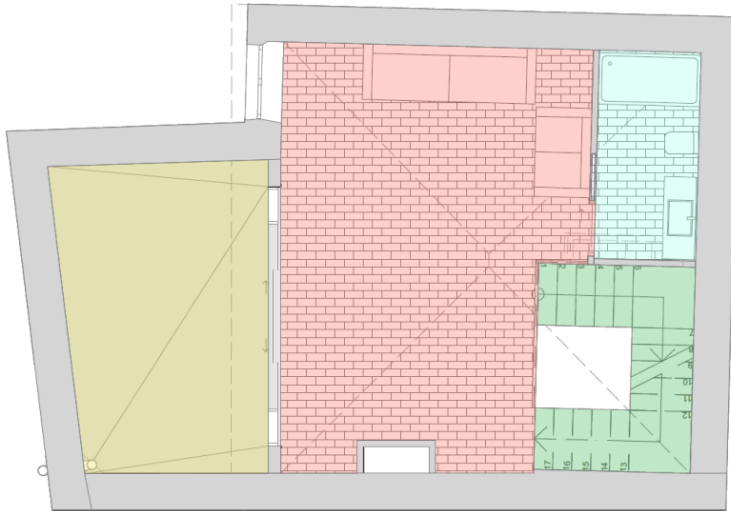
Nueva distribución planta segunda. Fuente: Autor.
